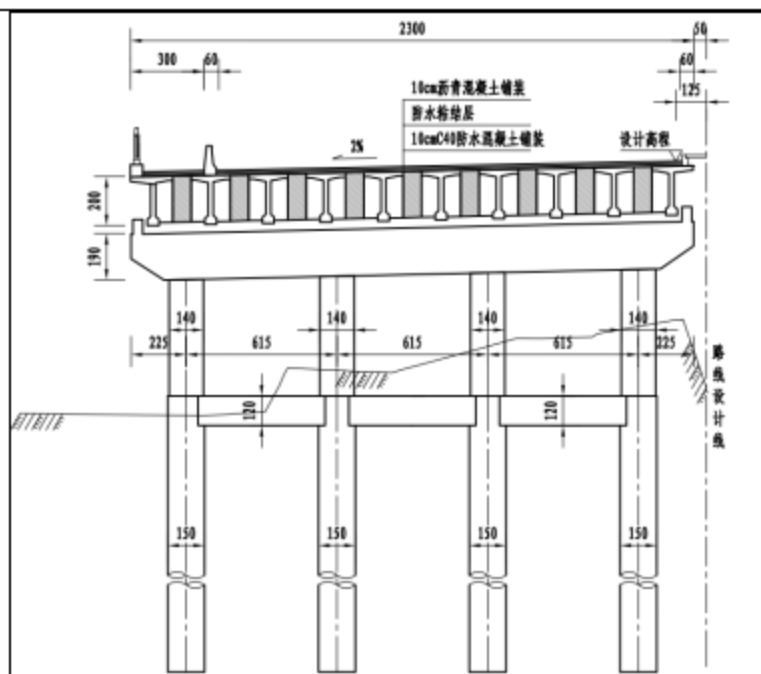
剑溪河大桥新建左半幅桥梁桥面及桥墩立面图
